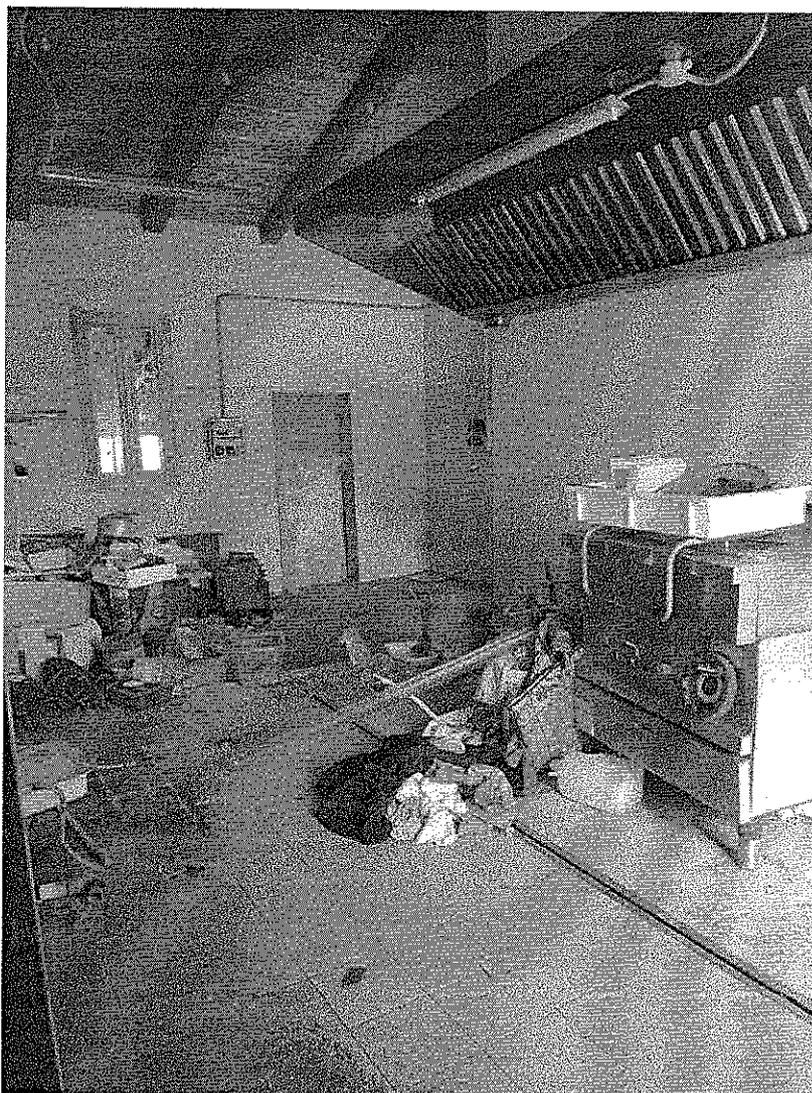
particolare stanza dell'abitazione unita di fatto con magazzino adiacente sub.4 (parete demolita)
